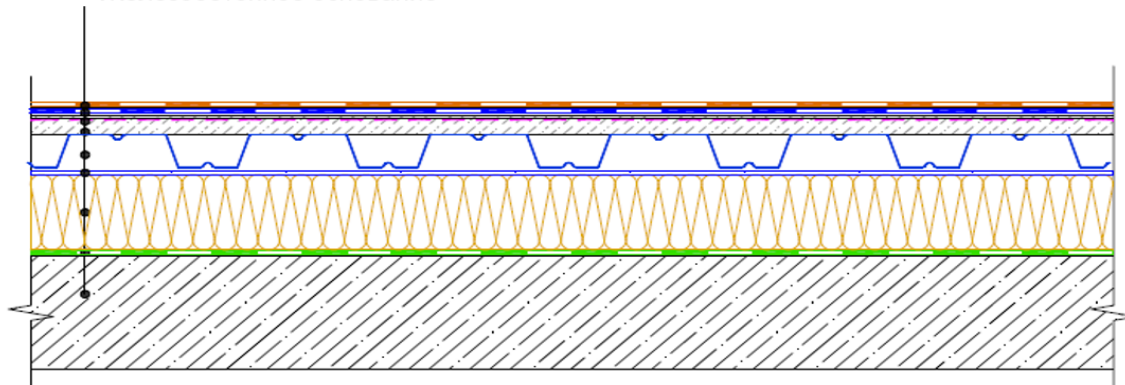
Разрез системы совмещенной вентилируемой крыши
